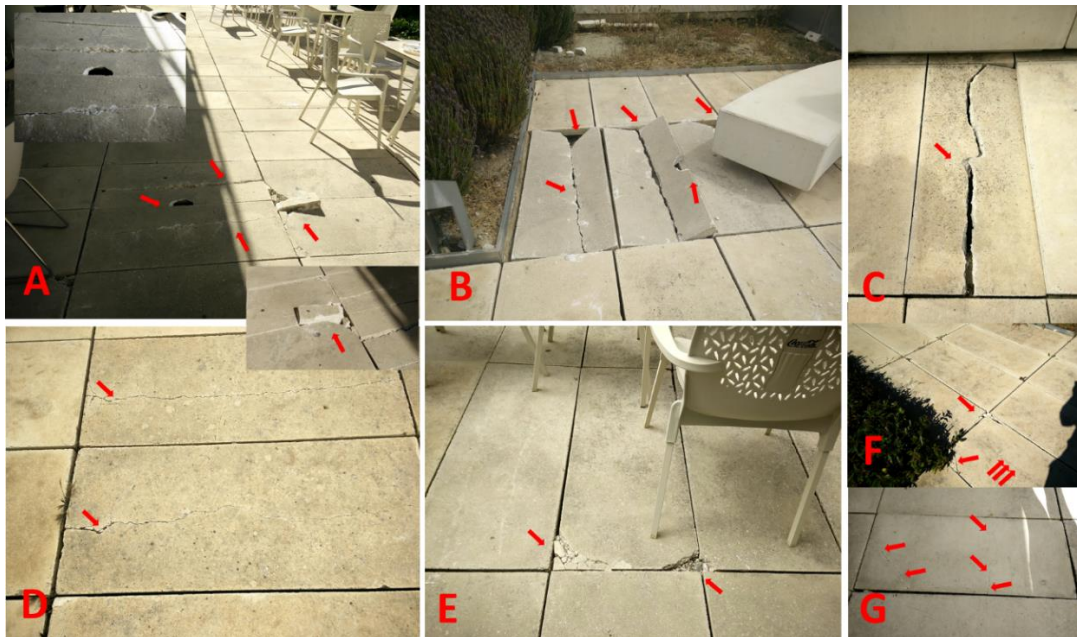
La evolución del deterioro de las losas comienza con grietas incipientes o deterioros en las esquinas (D, E, F, G). Las grietas suelen progresar de manera longitudinal hasta que la losa se fragmenta (B, C). El deterioro en los márgenes de las losas suele degenerar en orificios y fractura (A). La fragmentación y generación de orificios deja al descubierto un espacio hueco del tamaño suficiente como para suponer un grave peligro para los usuarios de la terraza (A, B)
